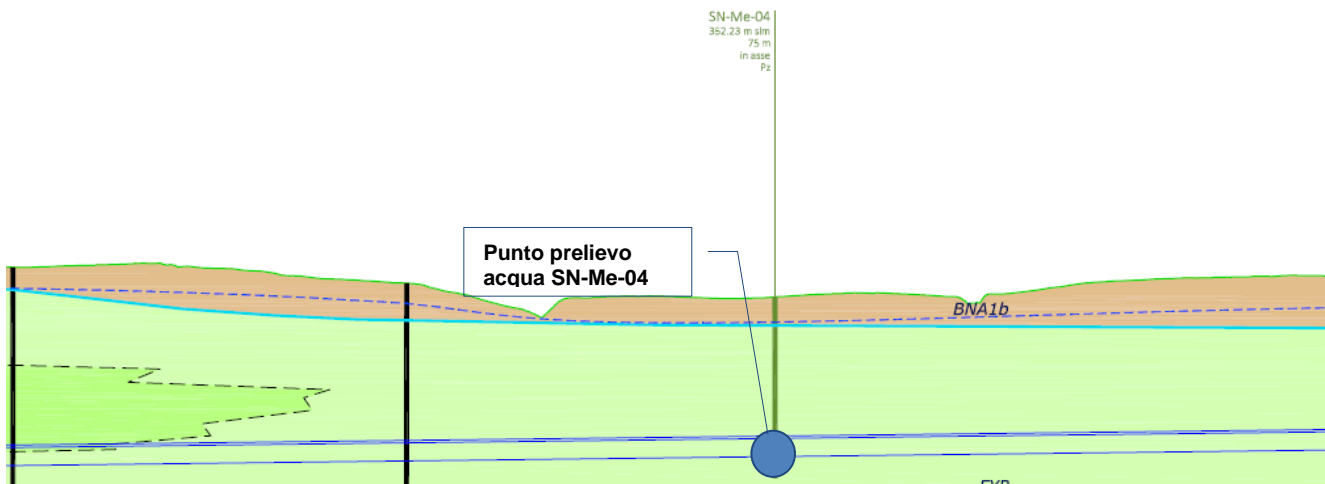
Galleria Melito: Posizione Piezometro SN\_Me\_04 rispetto alla galleria
